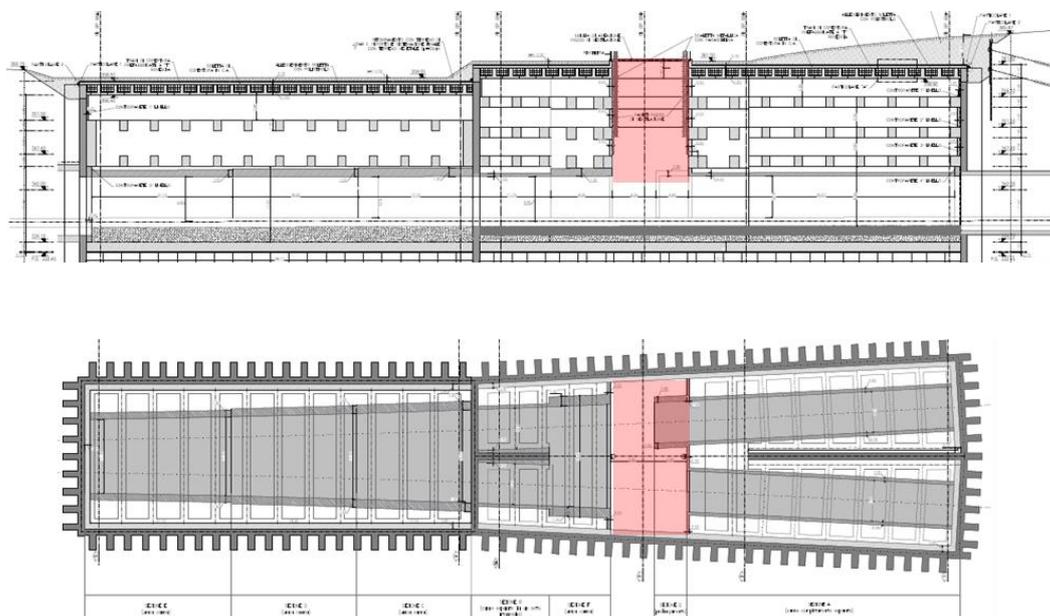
Sezione e pianta con la posizione del pozzo (evidenziata in rosso)
